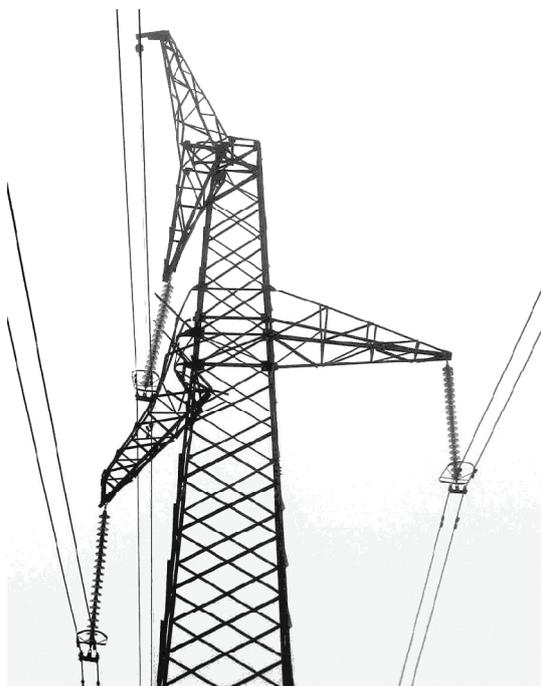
Разрушение металлоконструкций опоры № 181.
